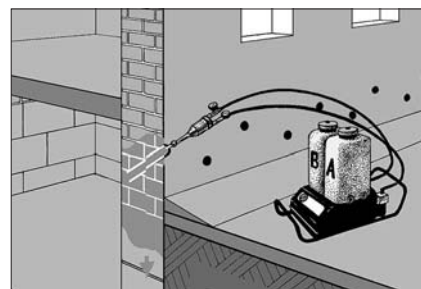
Схема заливки скважин гидрофобизирующим составом для горизонтальной гидроизоляции стены
